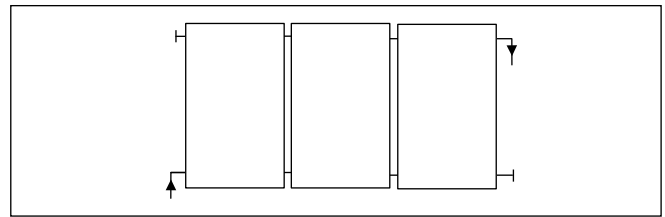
Collocazione su tetto inclinato con collettori adiacenti e collegamento contrapposto VFK 135/2 VD
